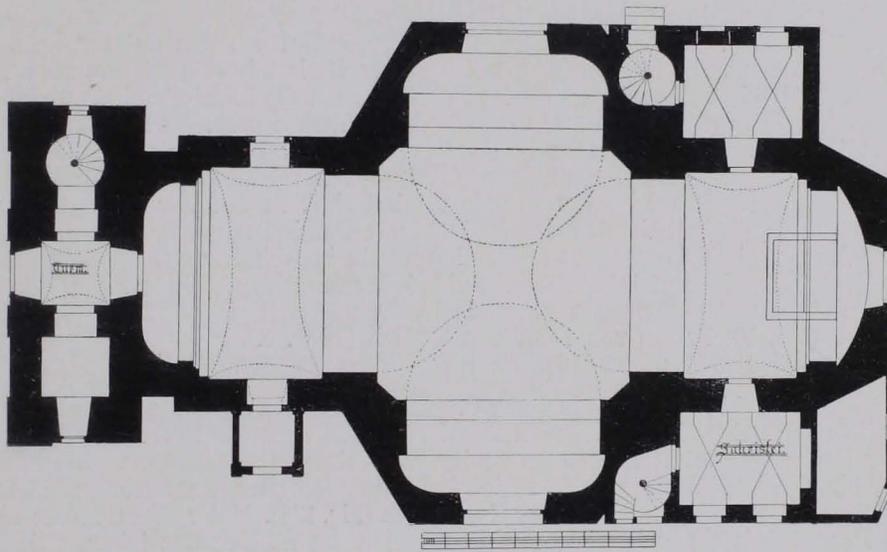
Groß-Siegharts, Pfarrkirche, Grundriß 1 : 300 (S. 133)
